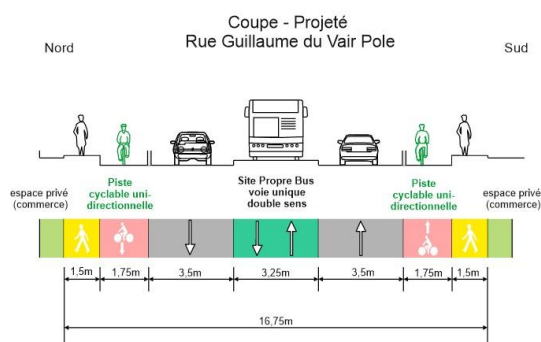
Profil en travers rue Guillaume du Vair Pôle
